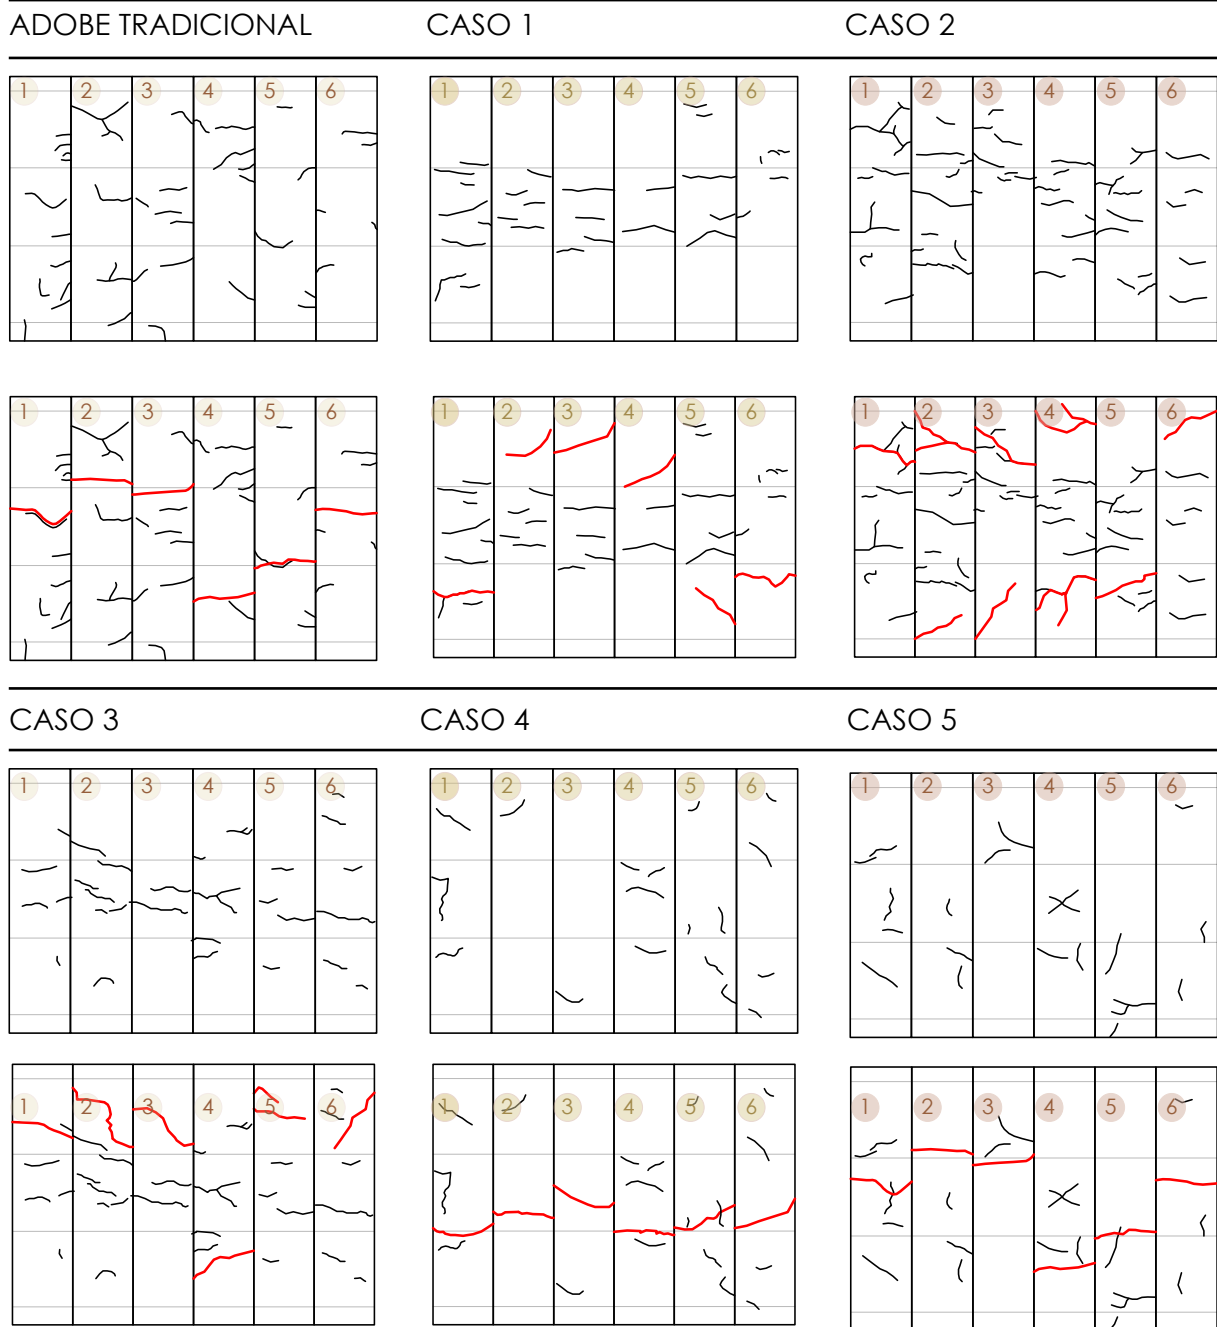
Fisuras y fallas de las muestras en el ensayo a flexión
